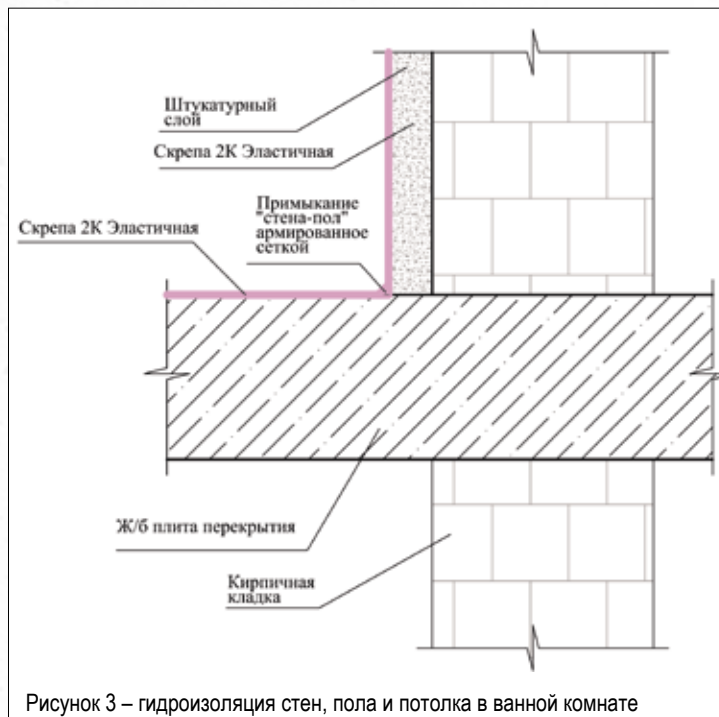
гидроизоляция стен, пола и потолка в ванной комнате
